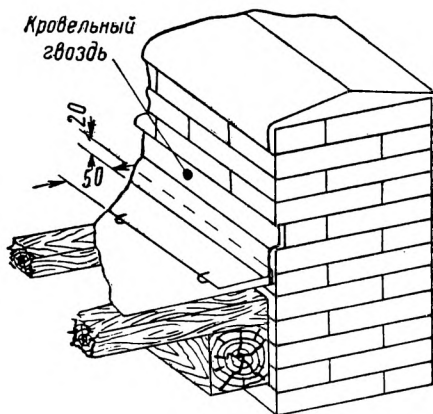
Примыкание рядового покрытия кровли к брандмауерной стене
